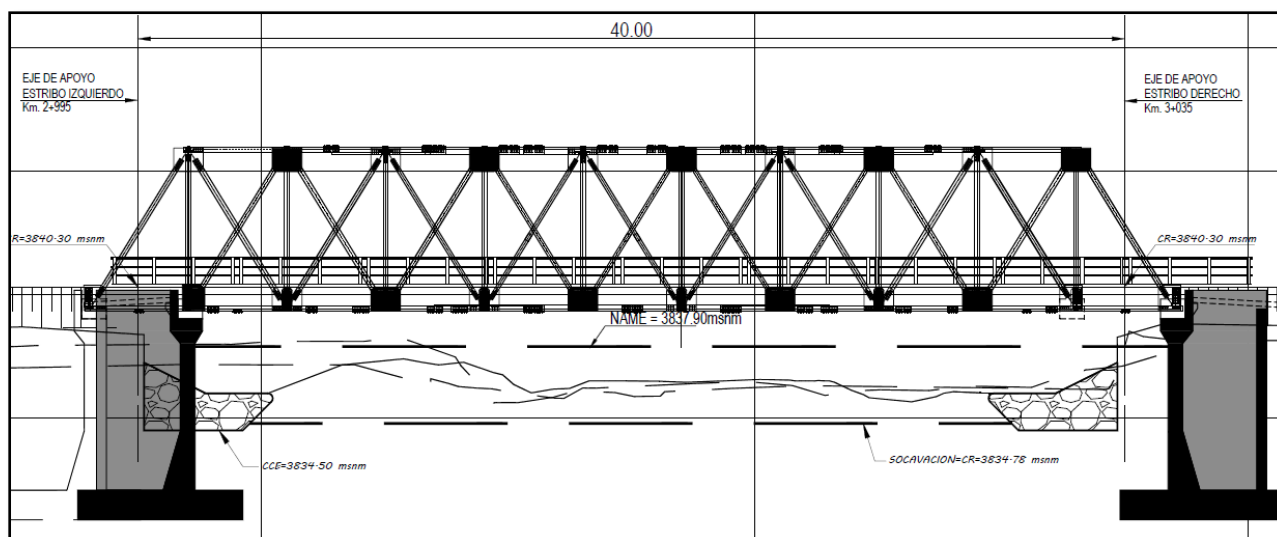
vista de la Superestructura y Sub estructura del Puente Tanana.
